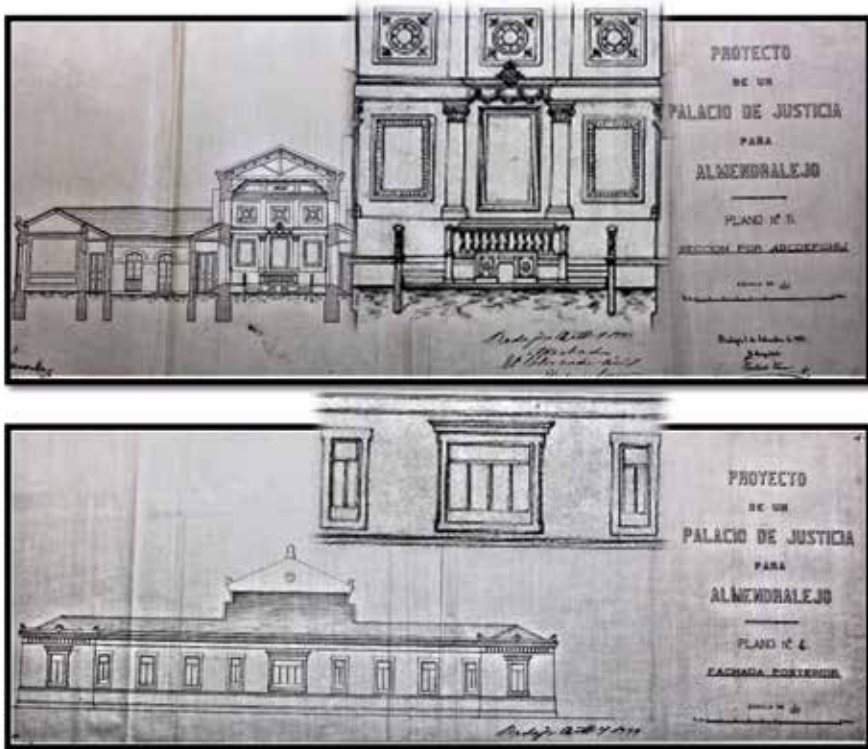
y 469. Planos proyectados para el levantamiento del Palacio de Justicia en Almendralejo. Legajo 111. Fuente: Archivo Municipal de Almendralejo.
